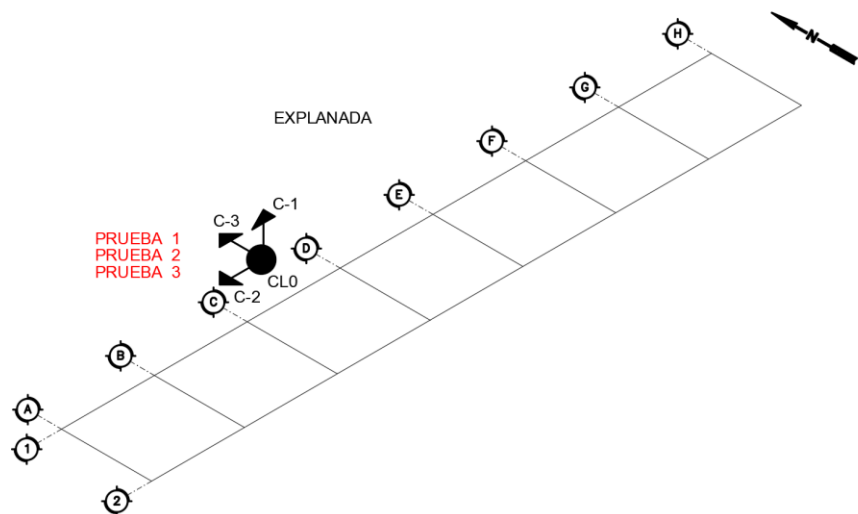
Instrumentación en terreno. Primer punto instrumentado para prueba 1, 2 y 3
